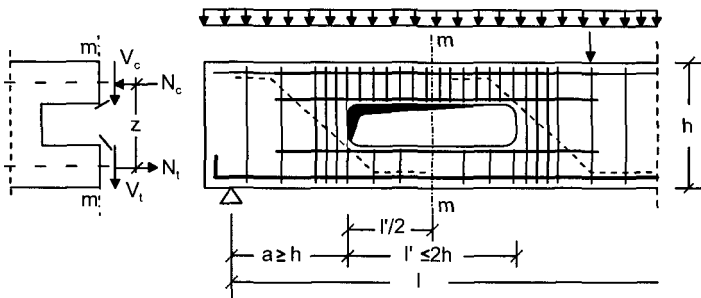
Bezeichnungen und Bewehrungsanordnung bei Balken mit rechteckigen Aussparungen [84]
